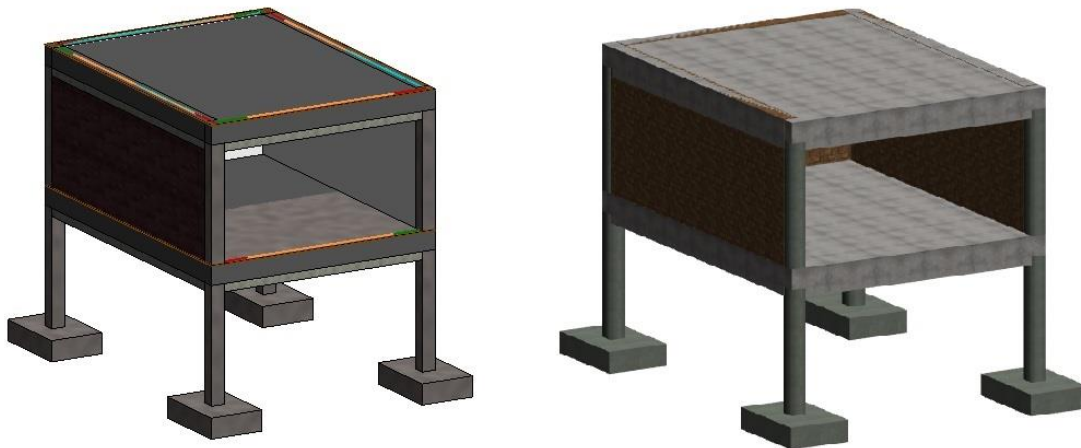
Garagem testada em Revit e ArchiCAD
